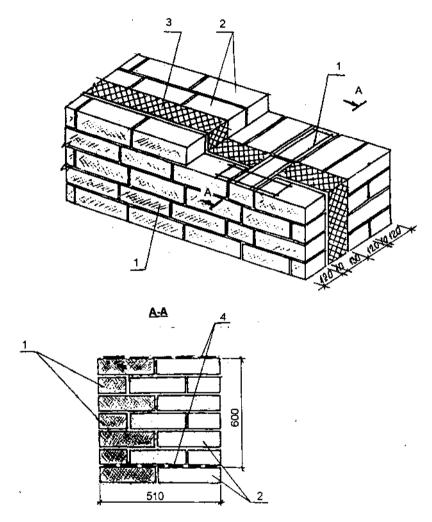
Кирпичная кладка наружных стен с жесткими связями и утеплением пенополистирольными плитами: 1 – лицевой кирпич; 2 – рядовой кирпич; 3 – плиты пенополистирольные; 4 – жесткие связи (арматурная сетка \varnothing 4-5 Bp 1)
